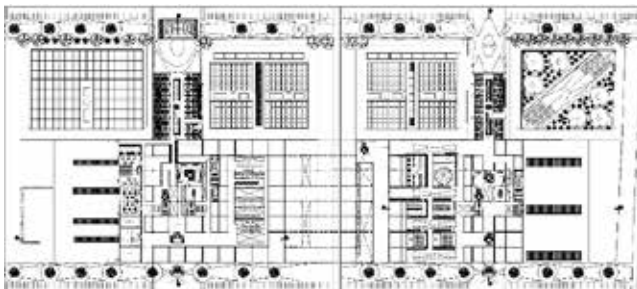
Planta Nivel 1. Fuente: Schaverin (2021)
